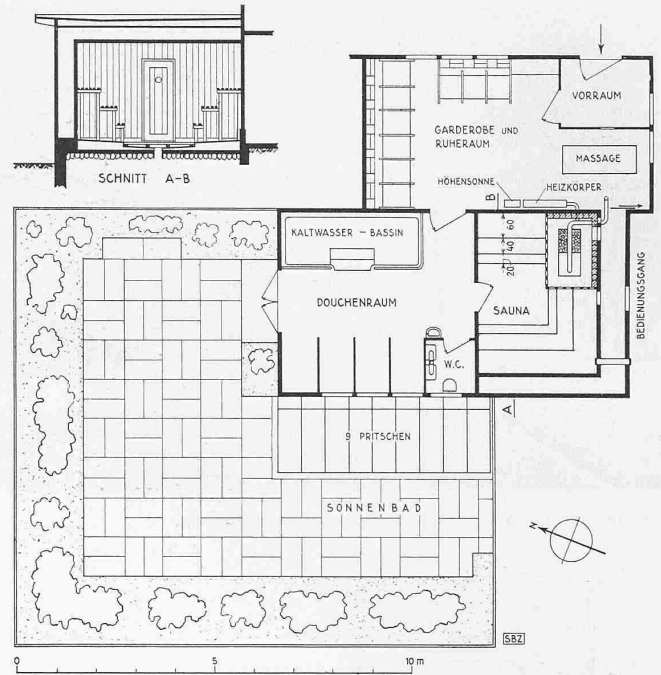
Grundriss und Schnitt der Anlage. — Masstab 1:170
